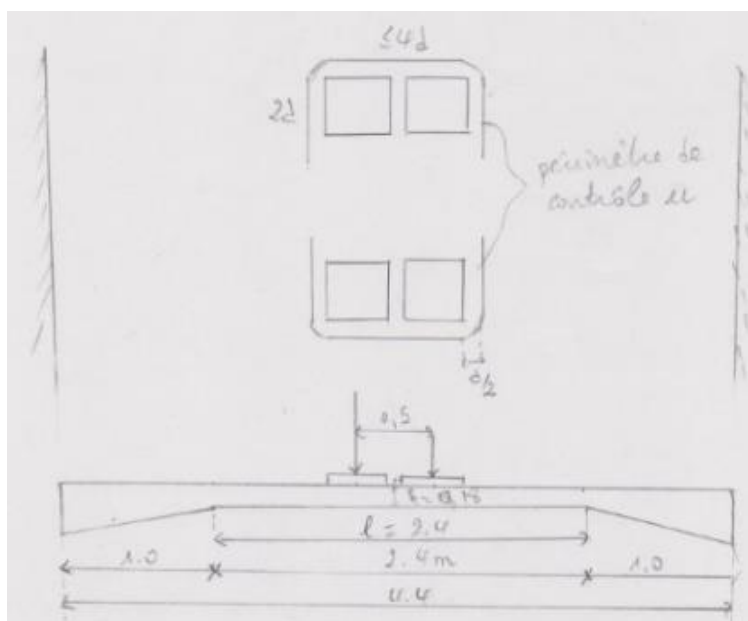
Disposition de charges admise pour la vérification au poinçonnement de la dalle entre poutre
